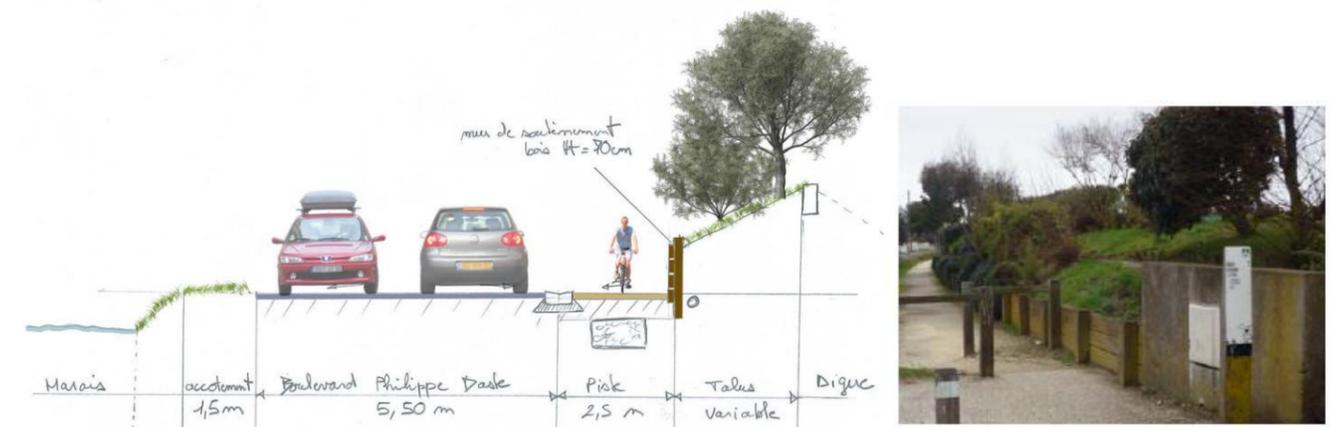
MURET DE SOUTÈNEMENT BOIS (SOURCE : SCE)
